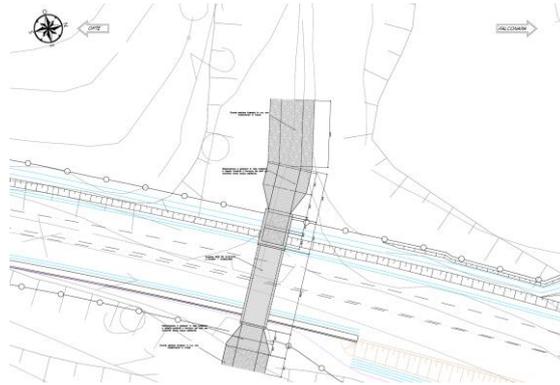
STRALCIO PLANIMETRICO – ELABORATO IR0P02R29PZID0000702A IDROLOGIA E IDRAULICA_SISTEMAZIONE IN02
